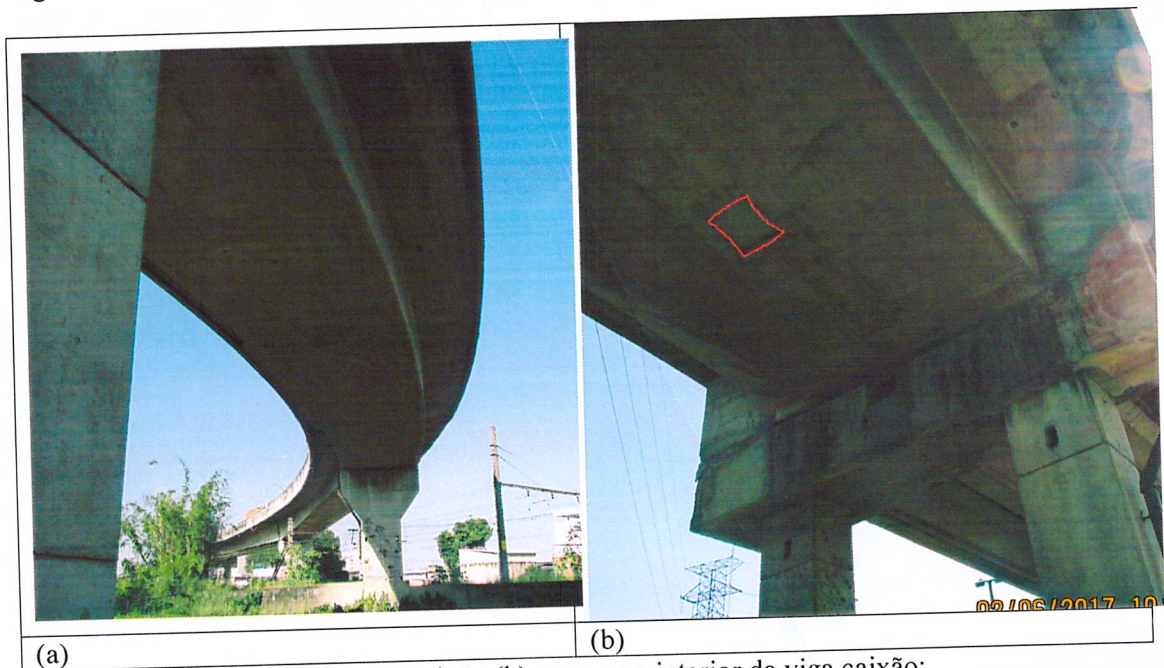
(a) vista inferior da viga caixão (b) acesso ao interior da viga caixão;
